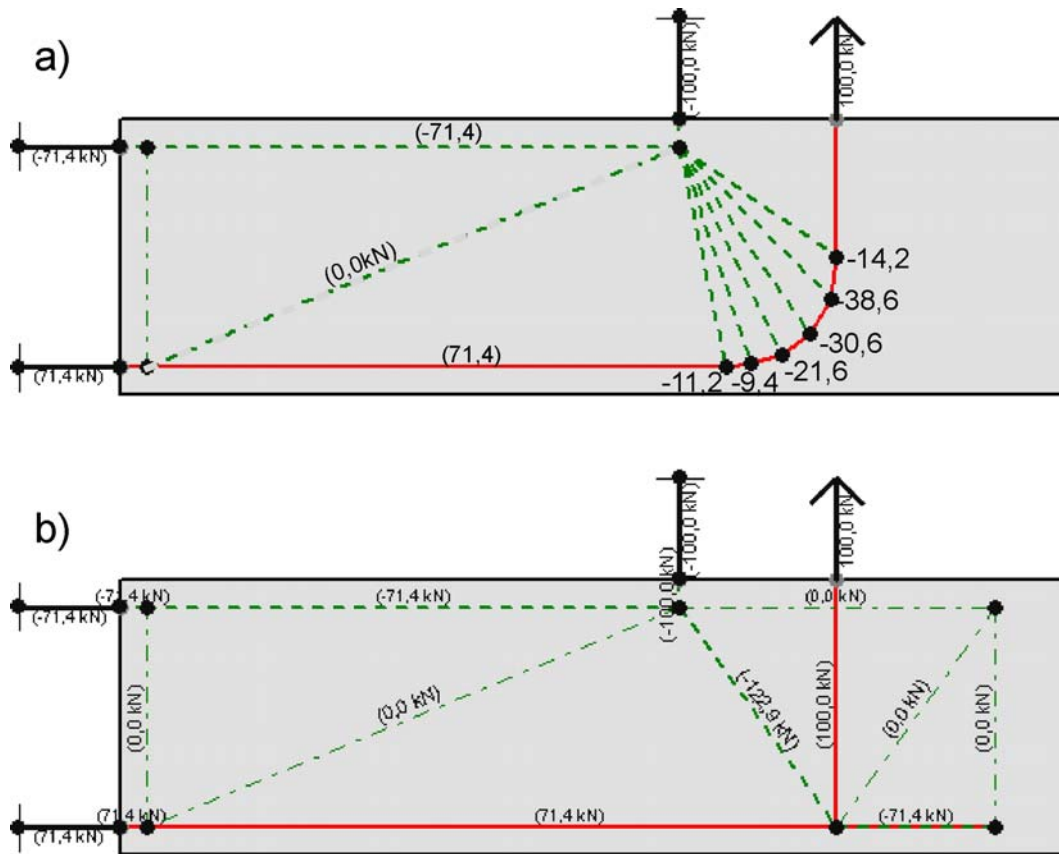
Vergleich der Lastabtragung der Systeme mit abgebogener Bewehrung Bild a) und mit Ankerstäben Bild b)
